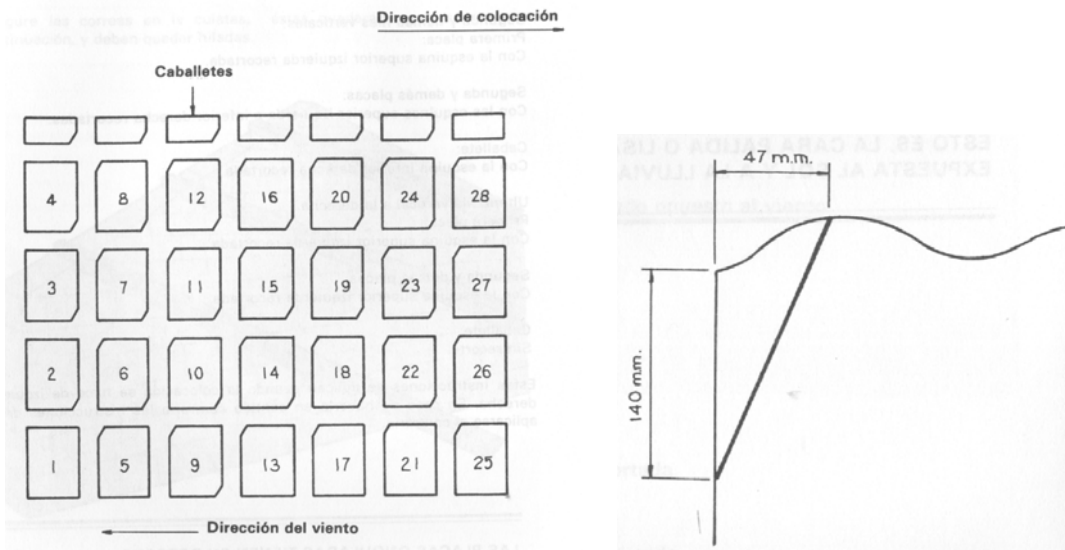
Corte y Traslapo de tejas por sistema de despunte
